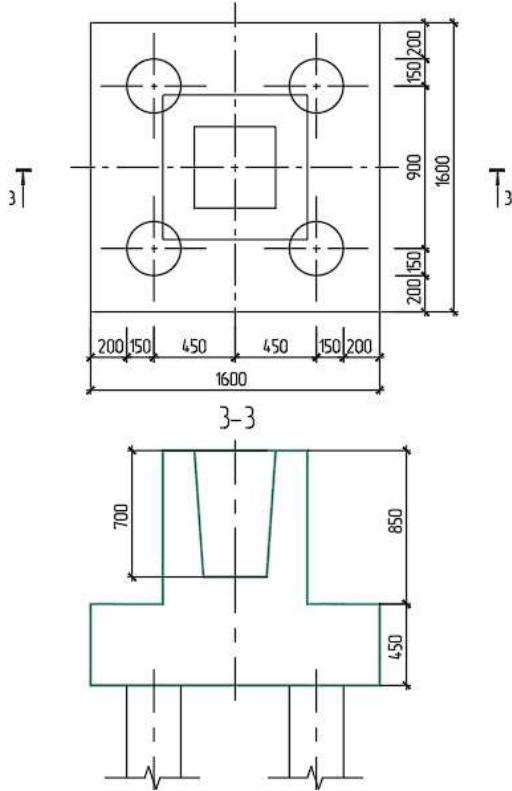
Схема к расчету ростверка на изгиб
